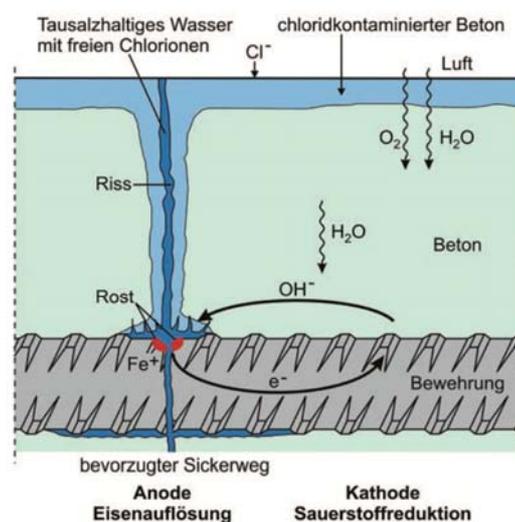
Chloridinduzierte Korrosion im Rissbereich
